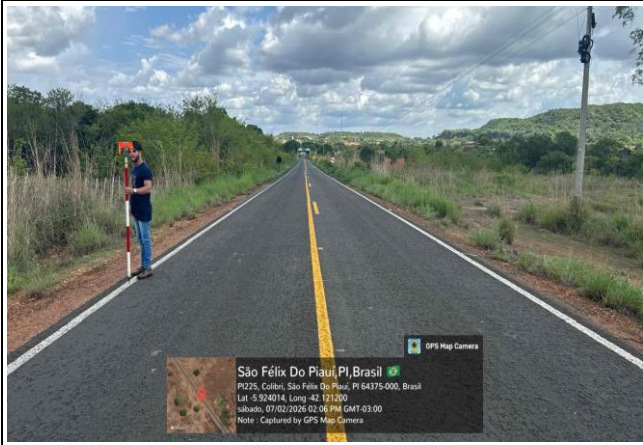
LOCAL PARA CONSTRUÇÃO DO PORTAL DE ENTRADA
